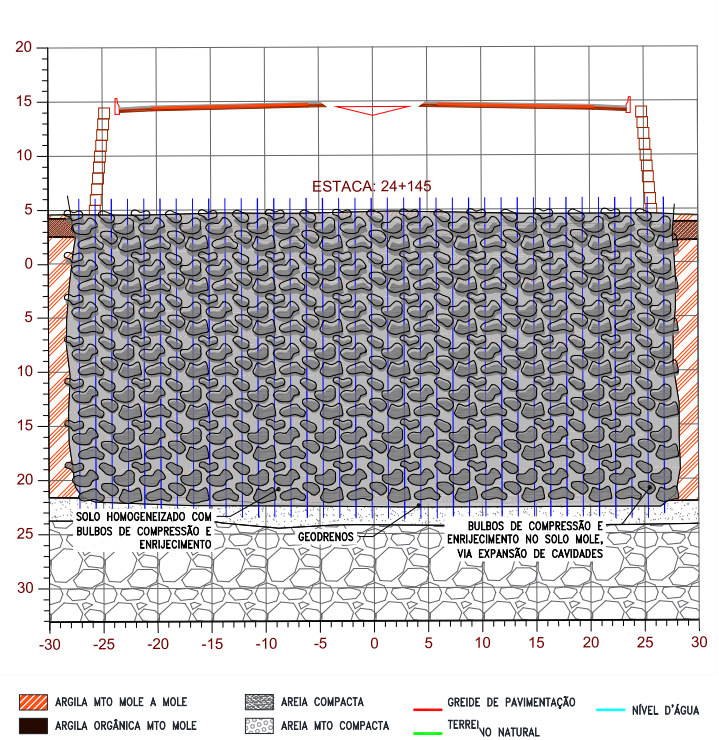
Corte transversal da Estaca 24+145 com Geoenrijecimento.
